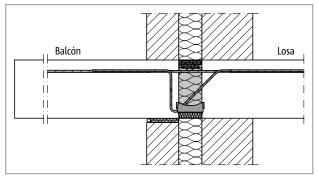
Schöck Isokorb® T tipo K: Conexión para muro doble con núcleo aislante
